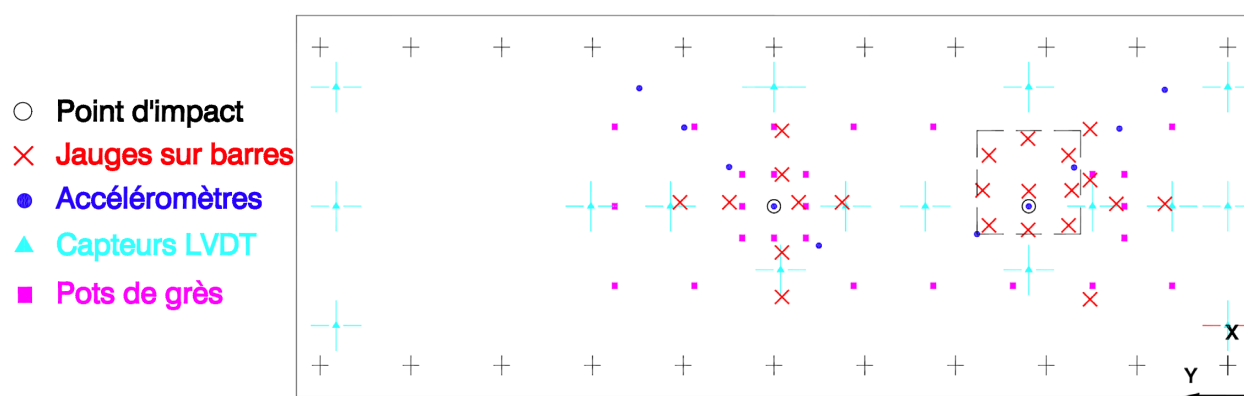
instrumentation pour les essais sur dalle horizontale
